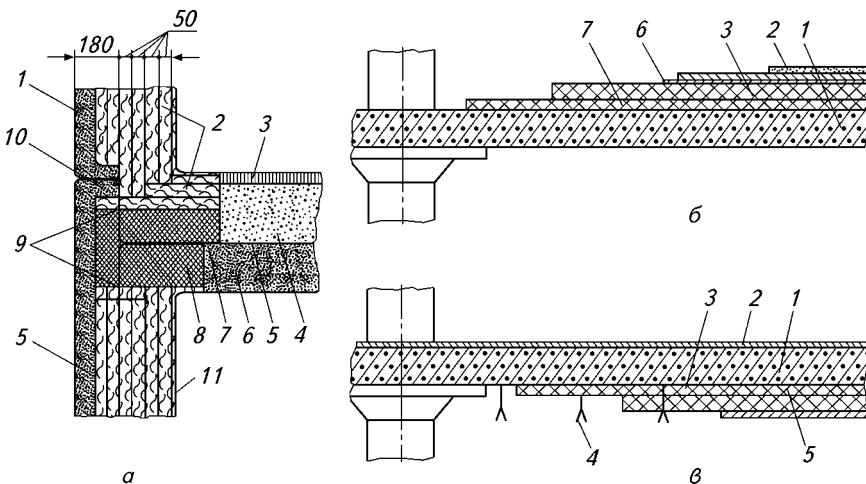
Тепло- и гидроизоляция сборной стены и межэтажного перекрытия:
